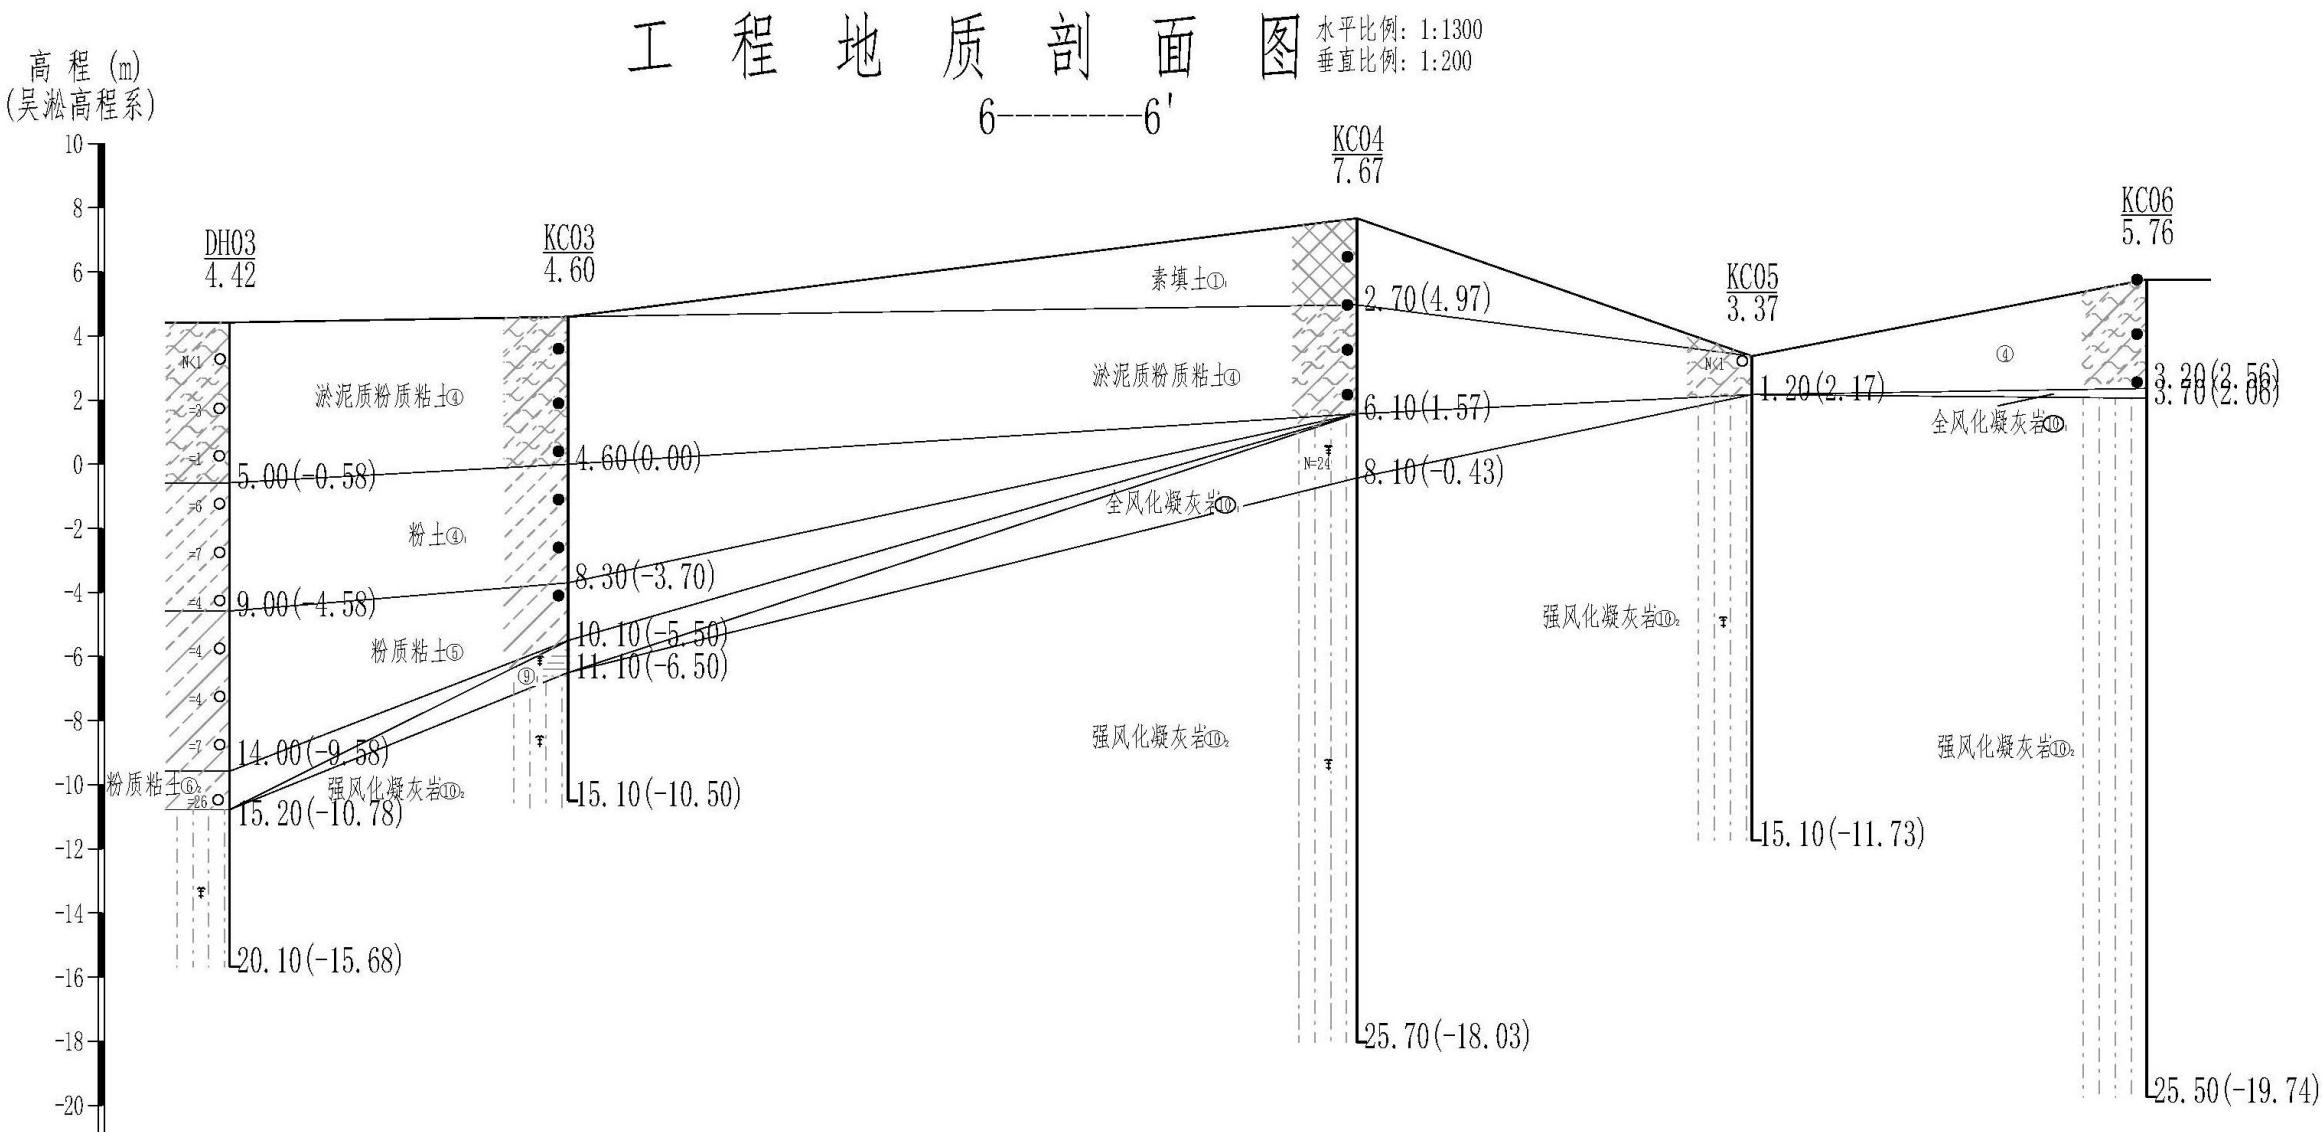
杨家湾船闸工程地质剖面图 (二)
